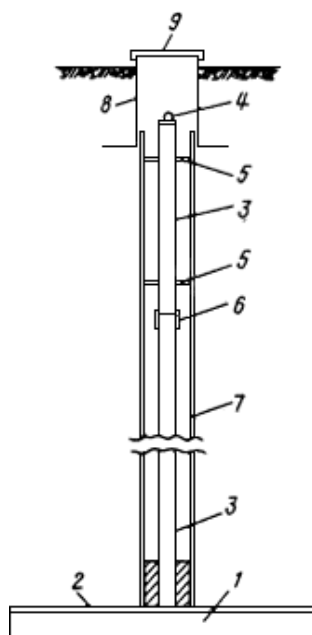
Плита-марка конструкции Гидропроекта: 1 – армированная плита; 2 – стальной лист; 3 – трубчатая штанга; 4 – марка с полусферической головкой; 5 – пружинящие скобы или диски; 6 – муфты соединений; 7 – труба; 8 – защитный колодец с крышкой 9
